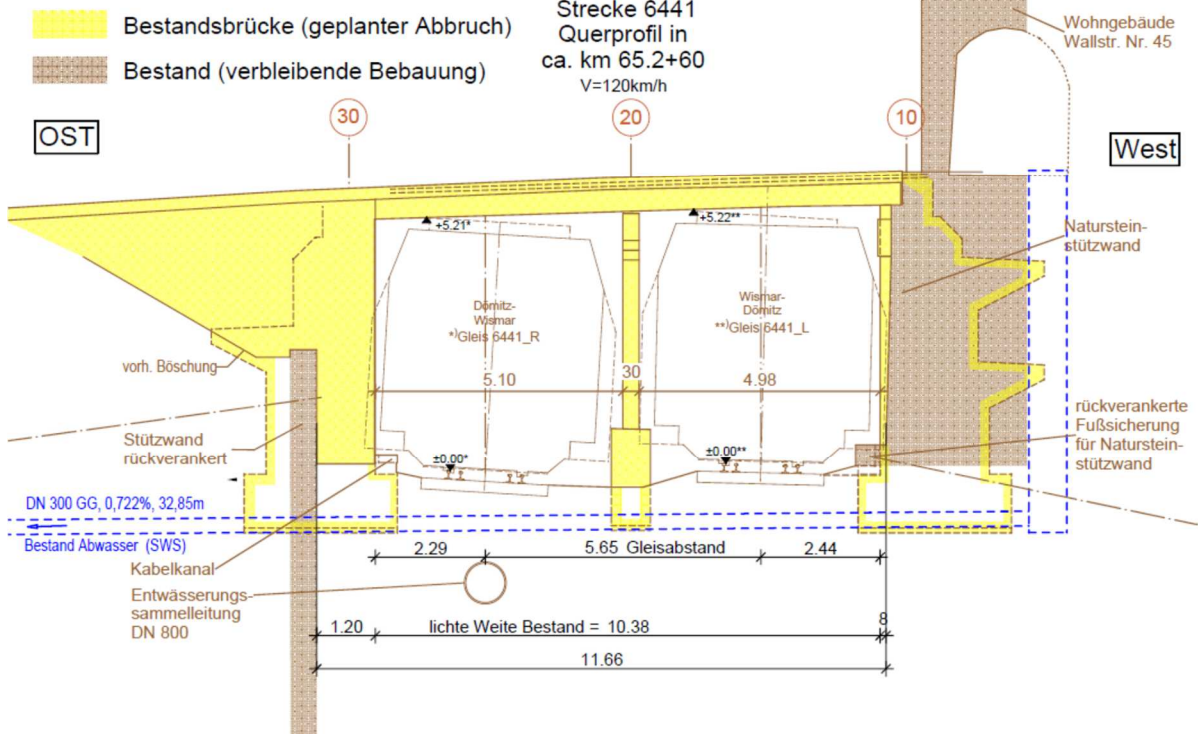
Lichtraum Bestandsbauwerk, Blick Richtung Süden (entgegen Kilometrierung DB Strecke)
